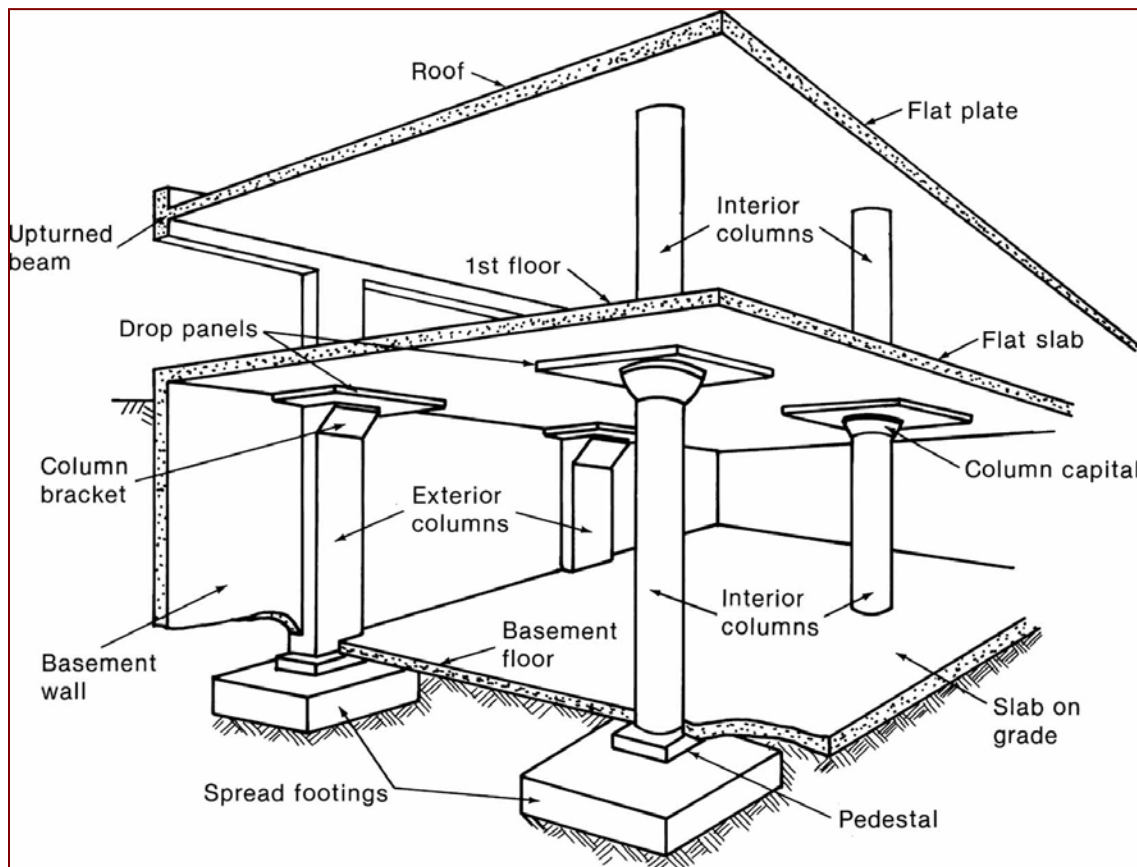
Elementos de un edificio de concreto reforzado. (Tomado de CRSI, 1971)
